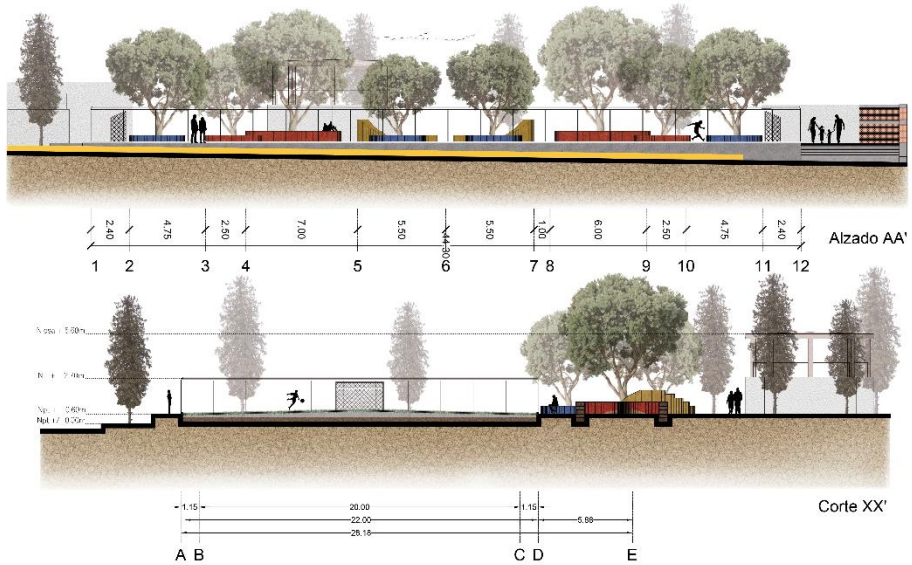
Alzado y corte de la propuesta final. (Autoría 2017).
